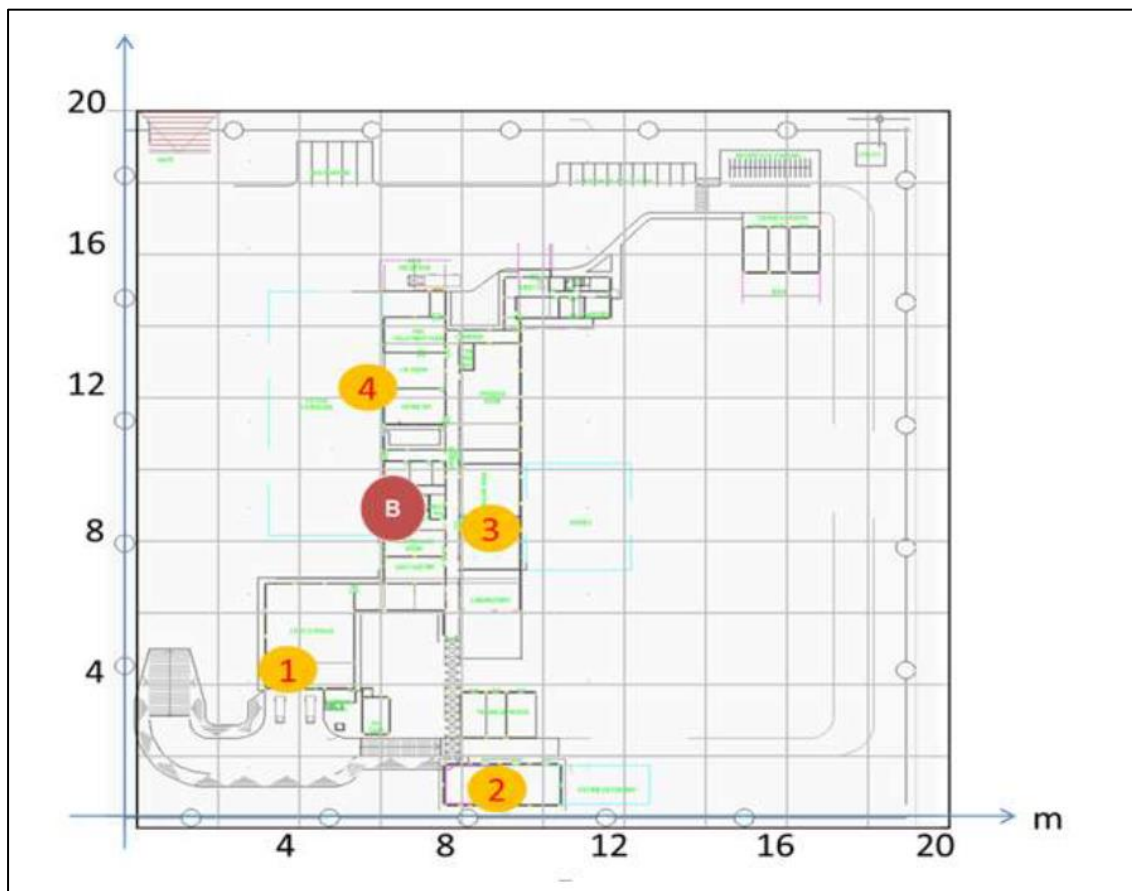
Planta baixa de fábrica com as cargas previstas e o baricentro calculado (ponto B)
